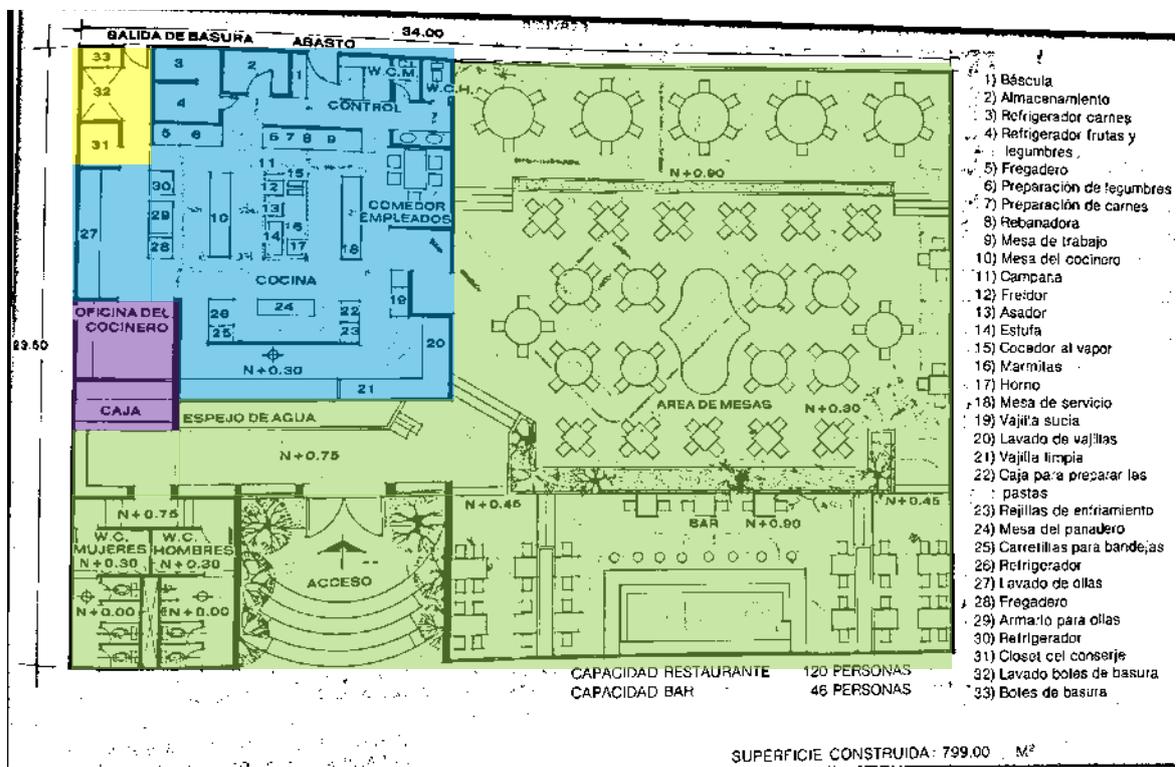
"Planta arquitectónica de un restaurante de especialidades"
